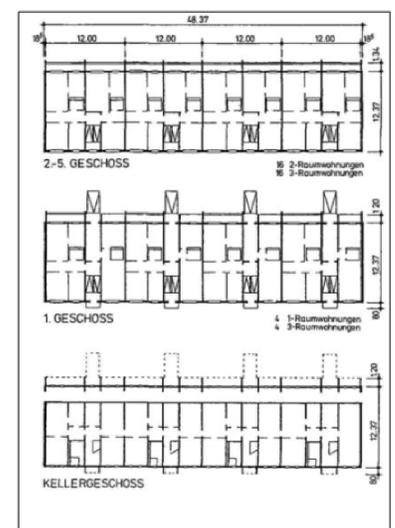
Fünfgeschossiges Mehrfamilienhaus der Wohnbauserie (WBS) 70, Grundrissdarstellung, [1]
